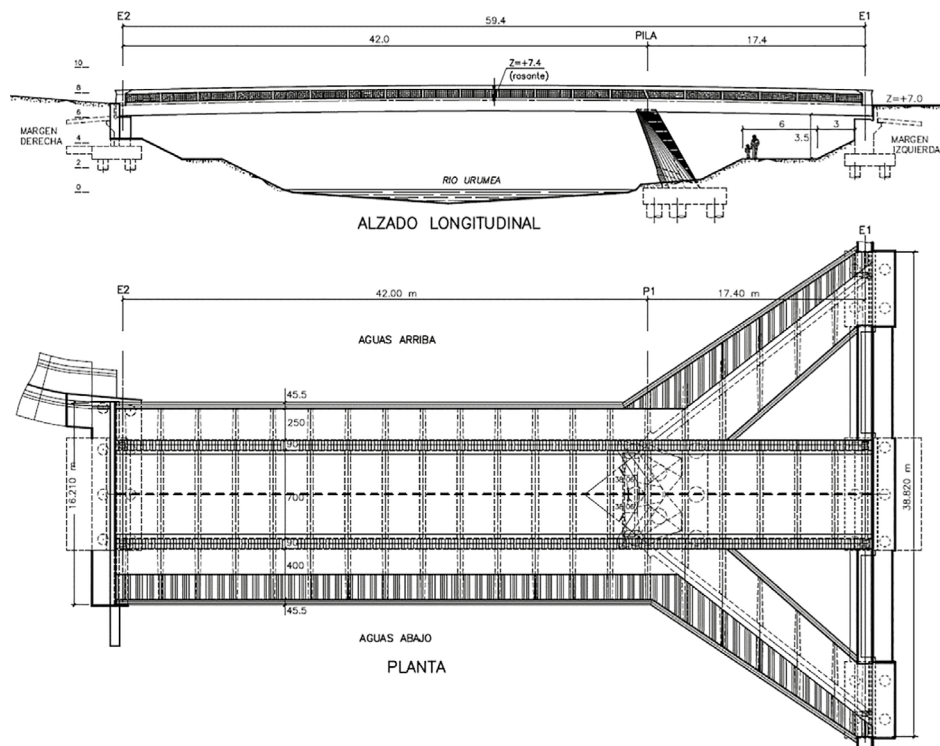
Planta y alzado del Nuevo Puente de Espartxo.
